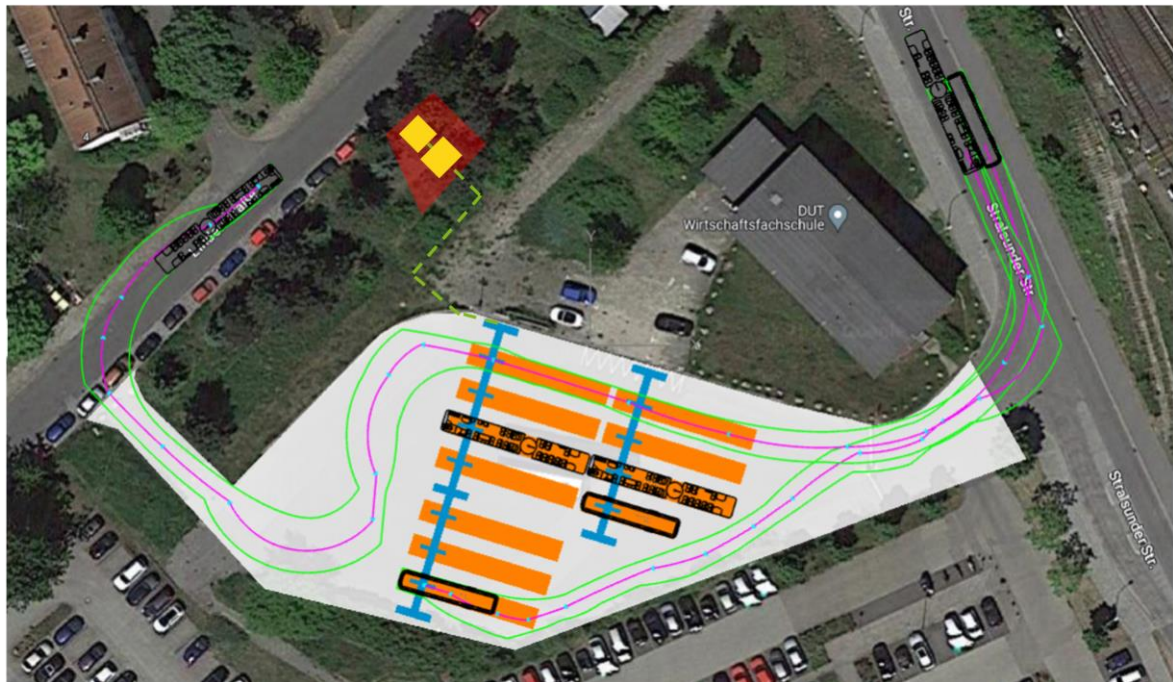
Stralsunder Straße Variante 2: 11 Ladepunkte (10 GL, 1 SL) und Ausfahrt über Lindenstraße mit Ladestationen/Trafo (gelb) und möglichem Leitungsverlauf (grün)
